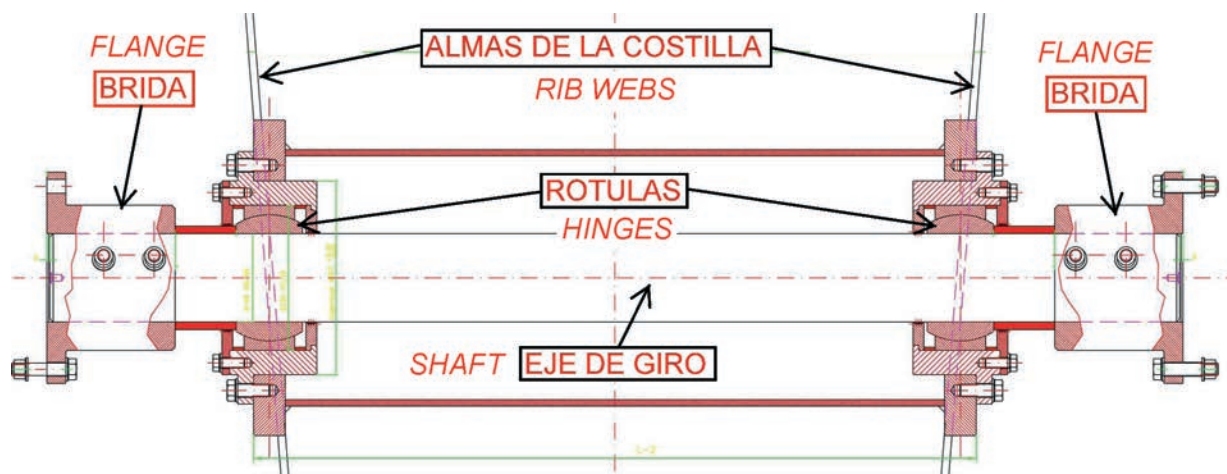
Detalle típico del sistema de arriostramiento. Ejes interiores de las costillas móviles, rótulas de giro y brida de conexión a las barras
